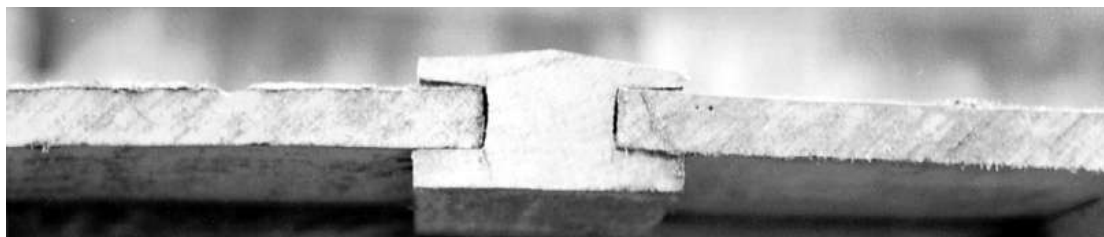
Detalhe do sistema construtivo em madeira serrada.
